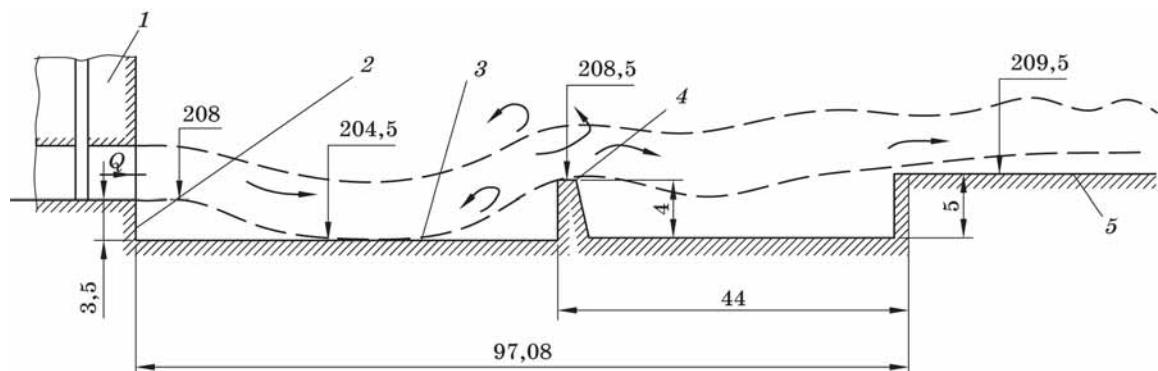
Продольный разрез конструкции нижнего бьефа донного туннельного водовыпуска-водосброса Юмагузинского гидроузла на стадии рабочих чертежей:
